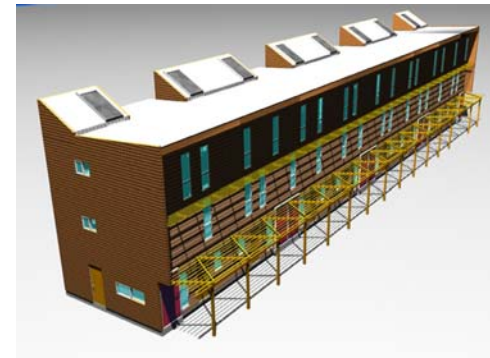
Perspectiva en isométrica del bloque de viviendas propuesto en su fachada norte.
